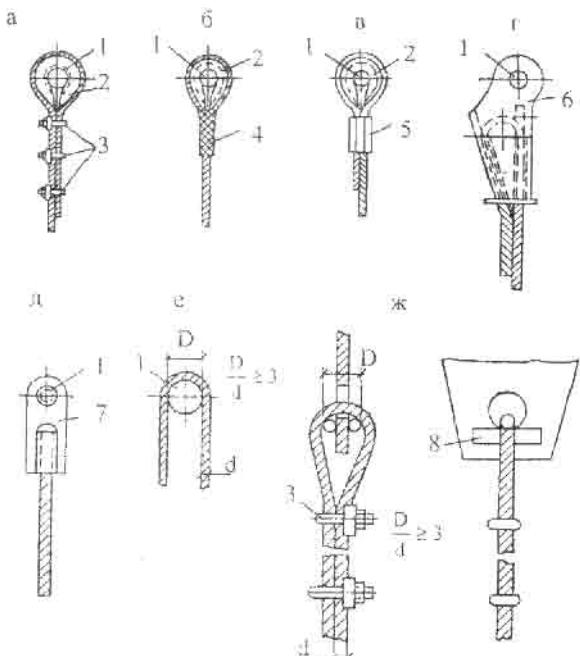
Схемы крепления канатных элементов в стальных конструкциях.
